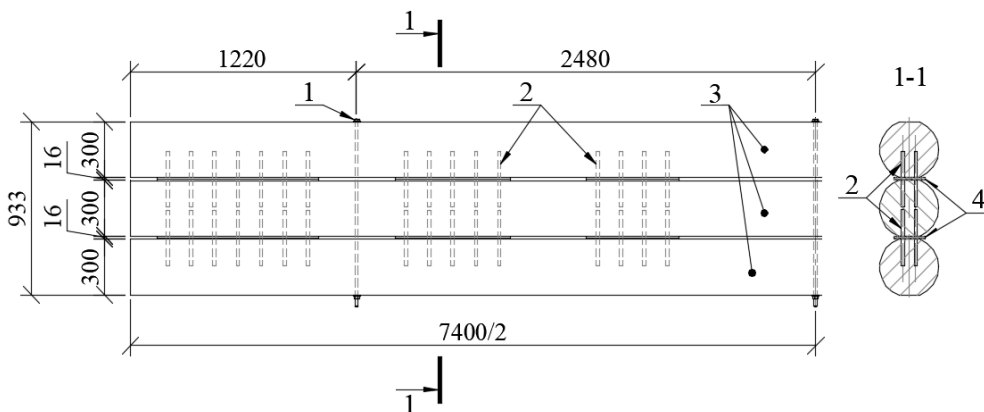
Конструктивная схема составного прогона из бревен: 1 – стяжной болт; 2 – гребенчатая шпонка; 3 – бревна диаметром 32 см; 4 – сварной шов
